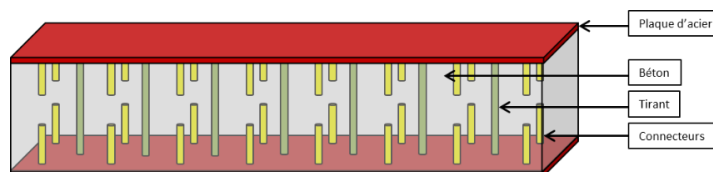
Schéma d'une poutre SCS avec goujons et tirants
